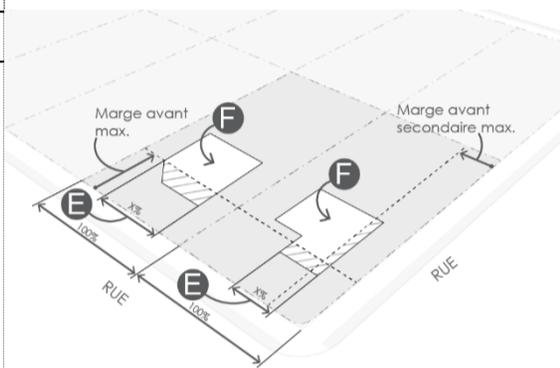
Front bâti et superficie d'implantation au sol d'un bâtiment
